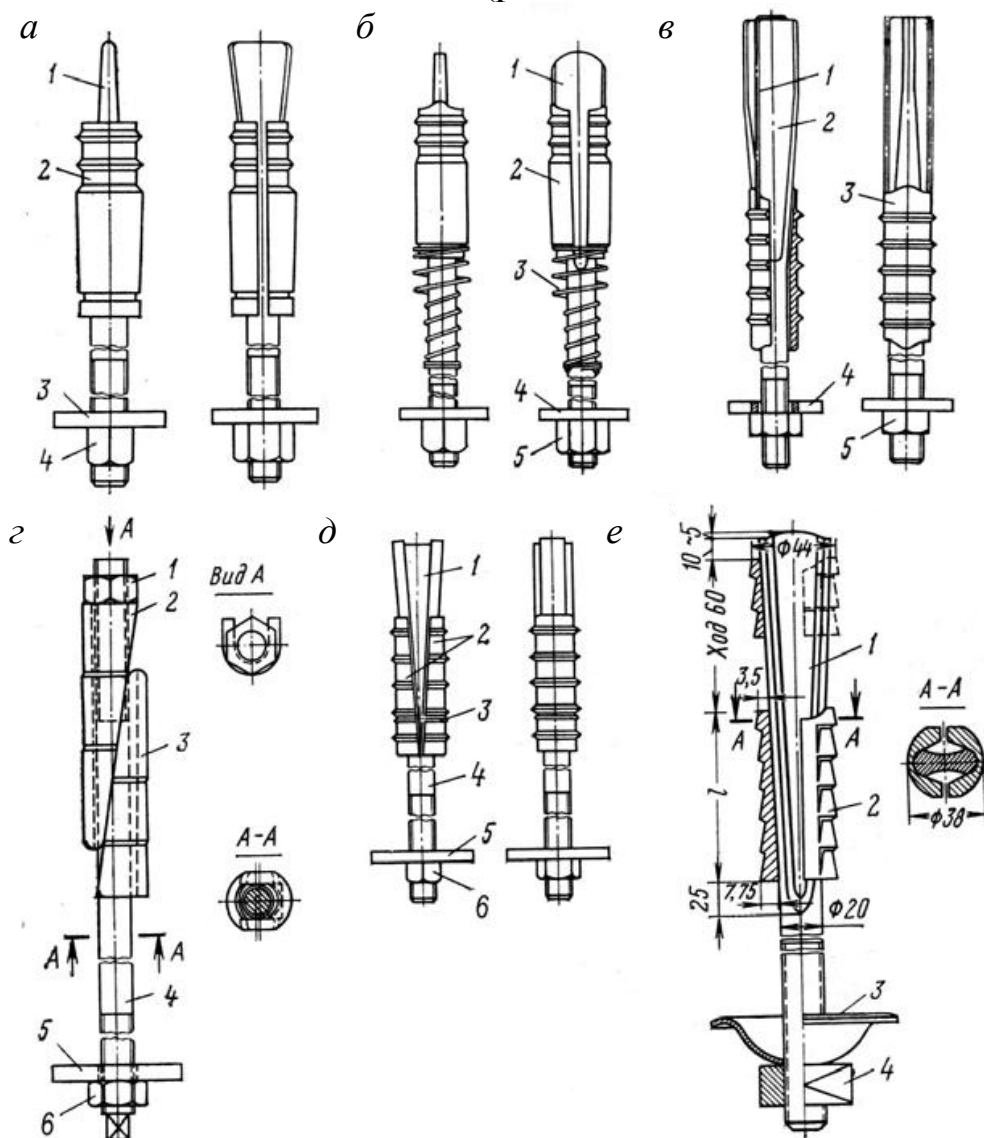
Металлические анкеры: а – ШК-1М; б – самозаклинивающийся ШК-3; в – АК-8; г – АД-1; д – АР-1; е – ЭС-2М
